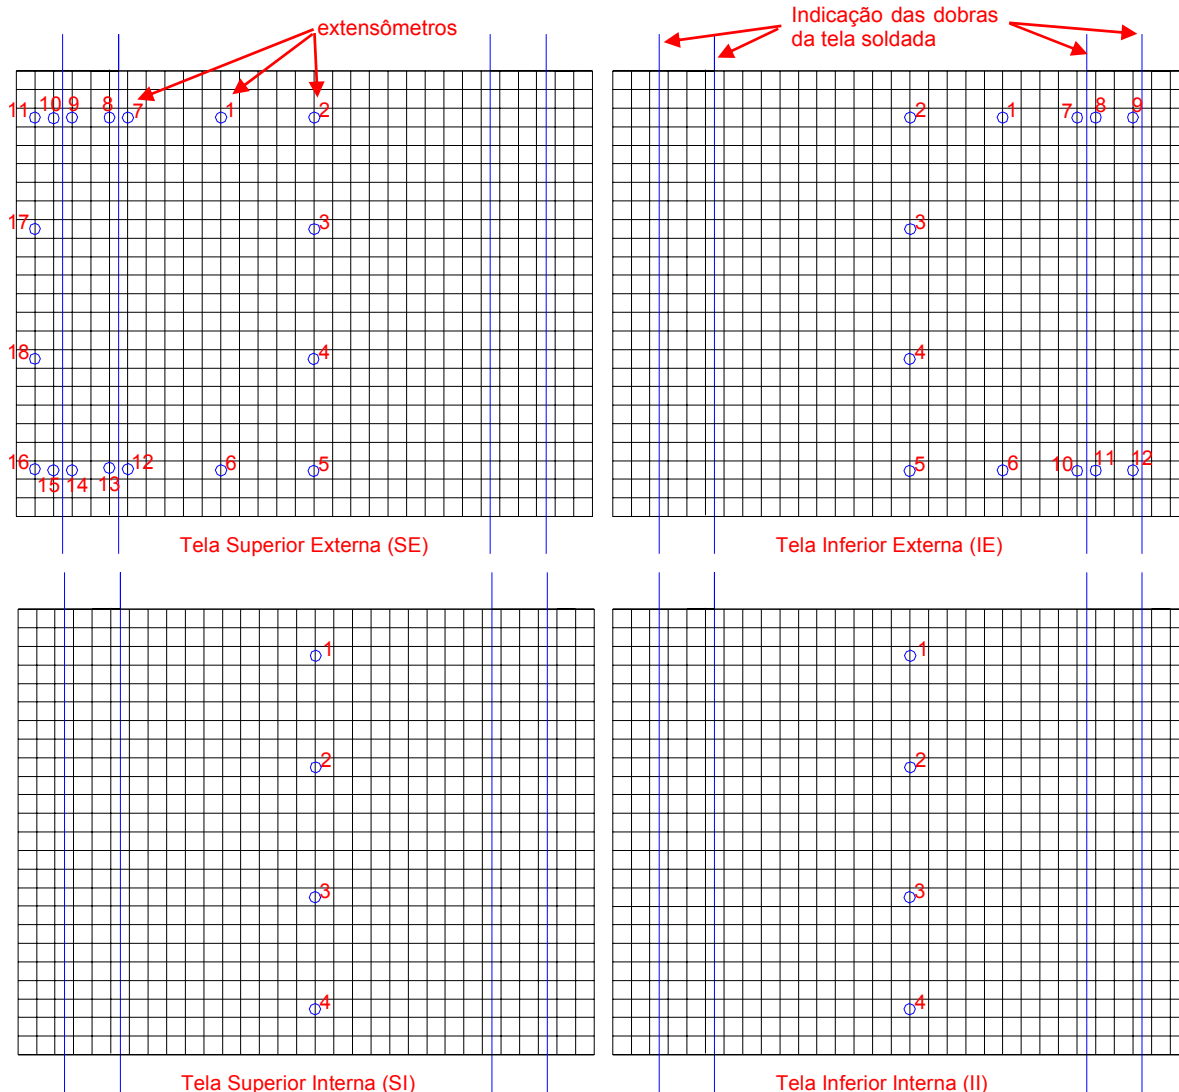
Posicionamento dos extensômetros na tela soldada.
